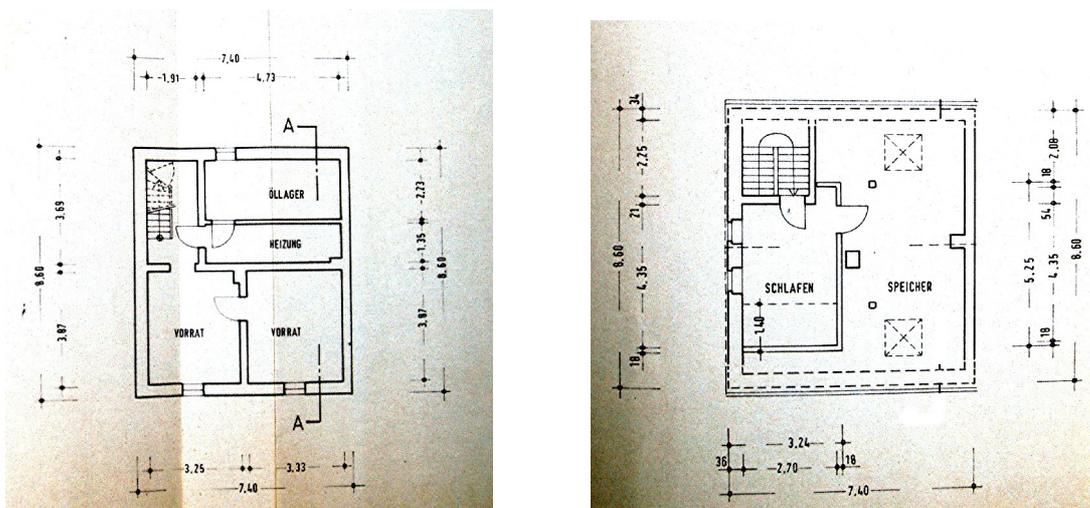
Haus Mertens, Kellergeschoss (links), Dachgeschoss (rechts)⁵⁶
